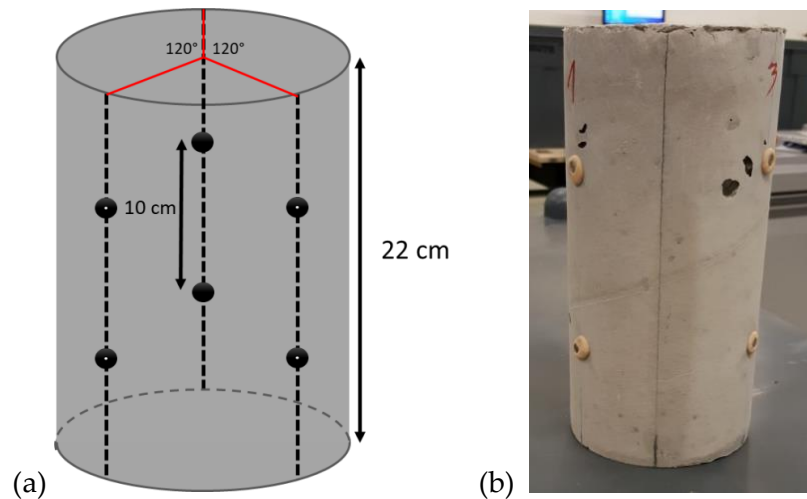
(a) Disposition des bases de mesures sur une éprouvette $\varnothing 11 - 22$ cm pour le suivi dimensionnel et (b) photographie d'une éprouvette instrumentée.
